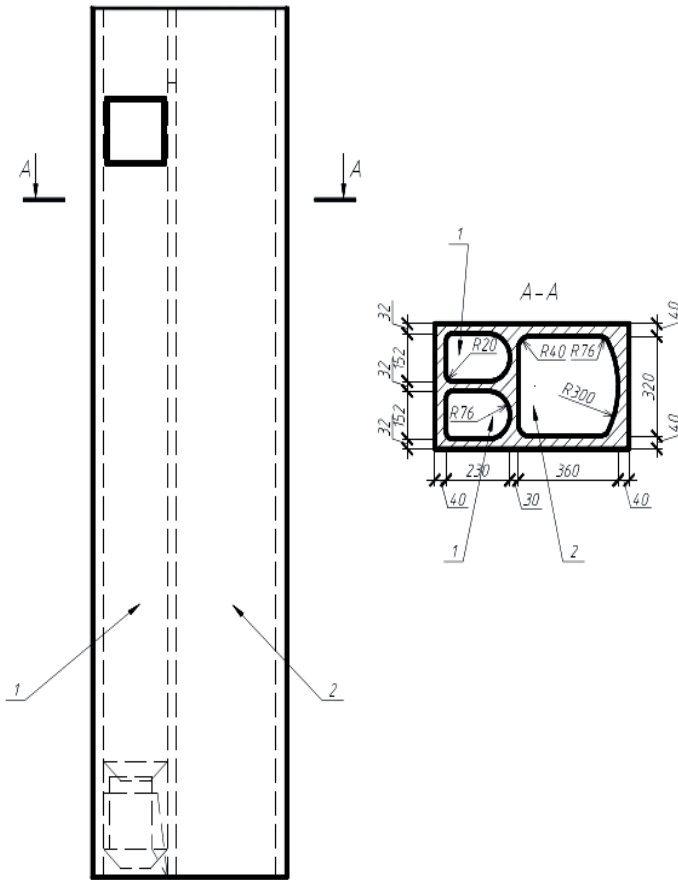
Конструкция унифицированного вентиляционного блока:
